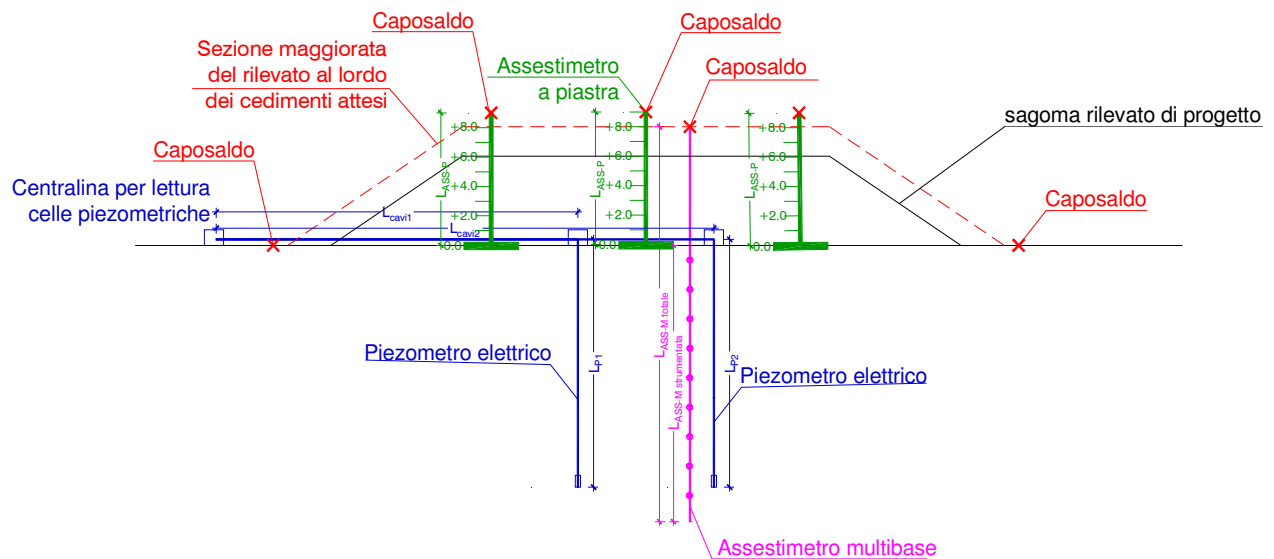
Sezione strumentata SM-R: schema indicativo della disposizione della strumentazione di monitoraggio.
